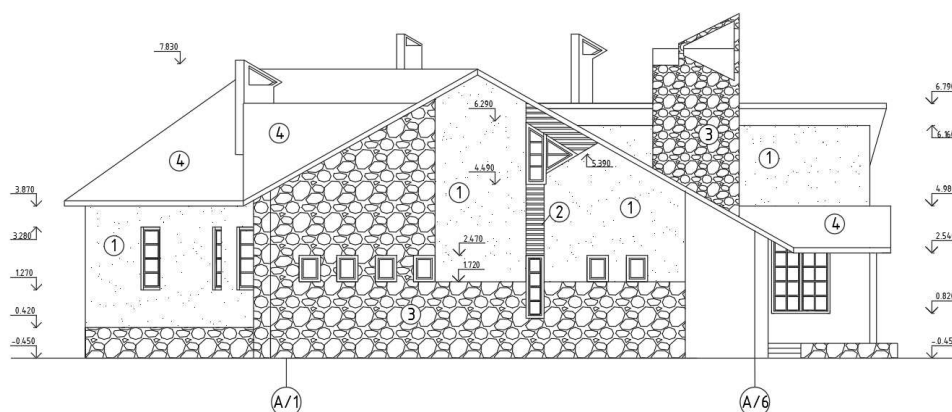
Архитектурные решения фасада А/1-А/6
